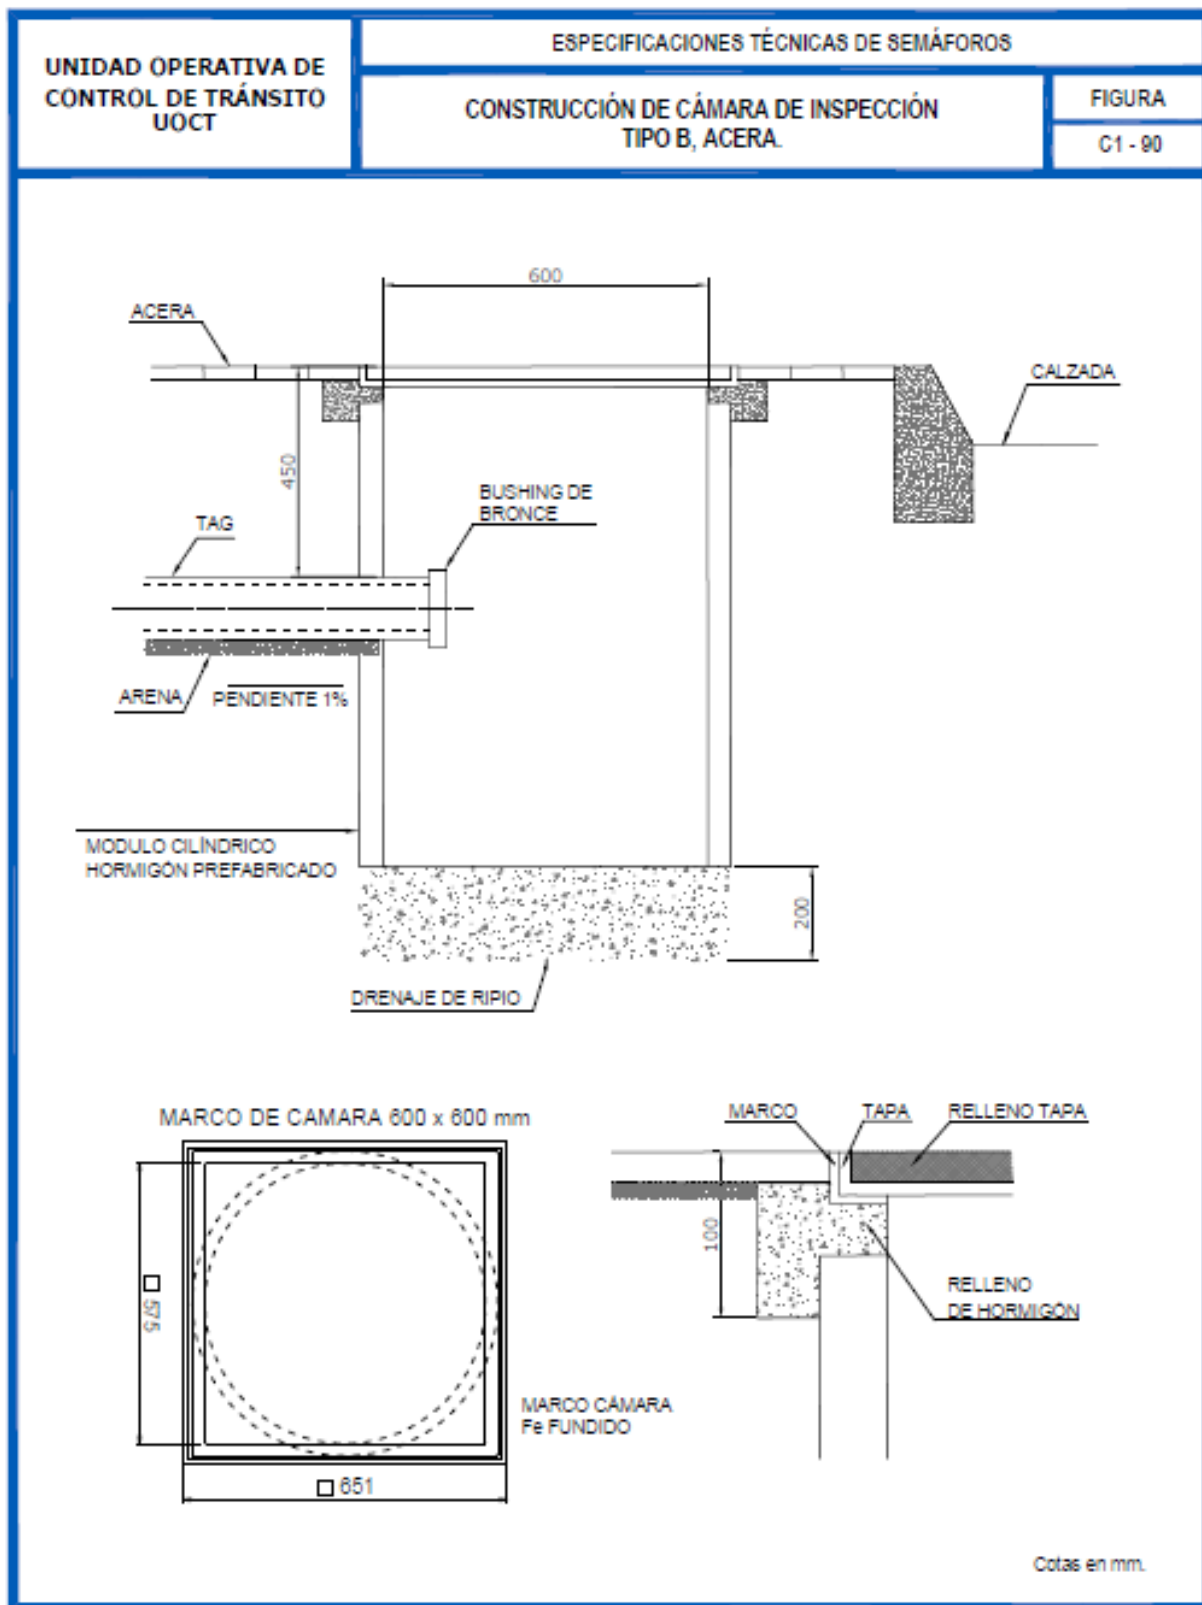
90 Construcción Cámara de Inspección Tipo B, Acera
